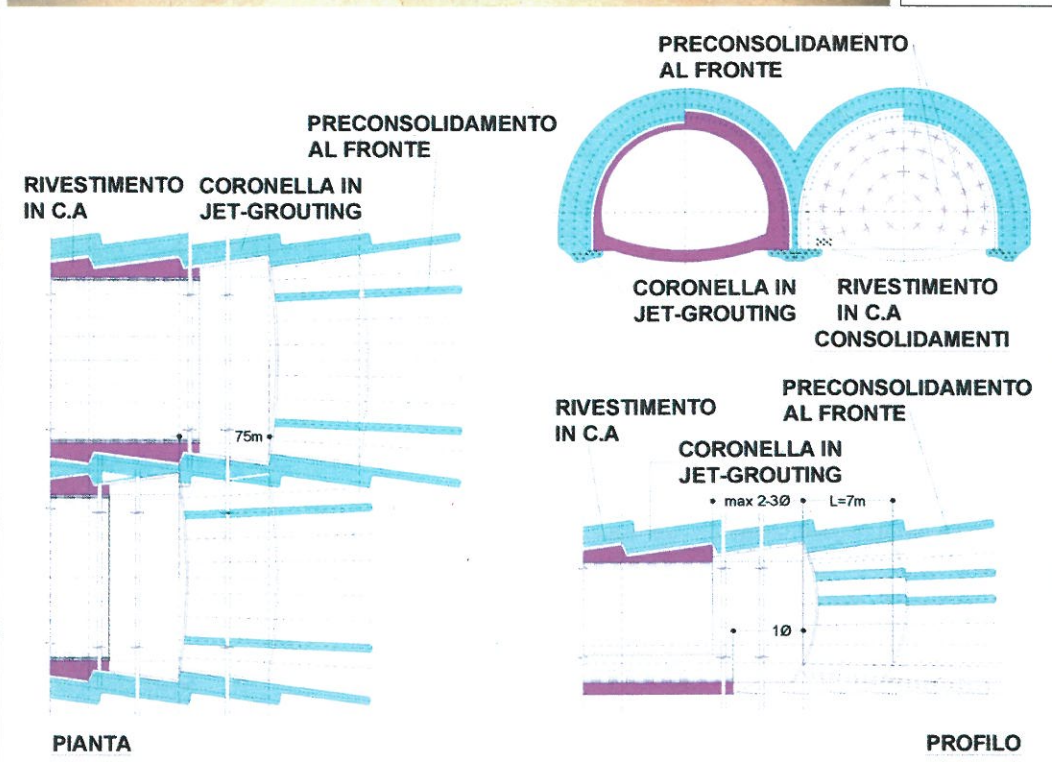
Schema dell'avanzamento mediante preconsolidamento al fronte con colonne jet-grouting
